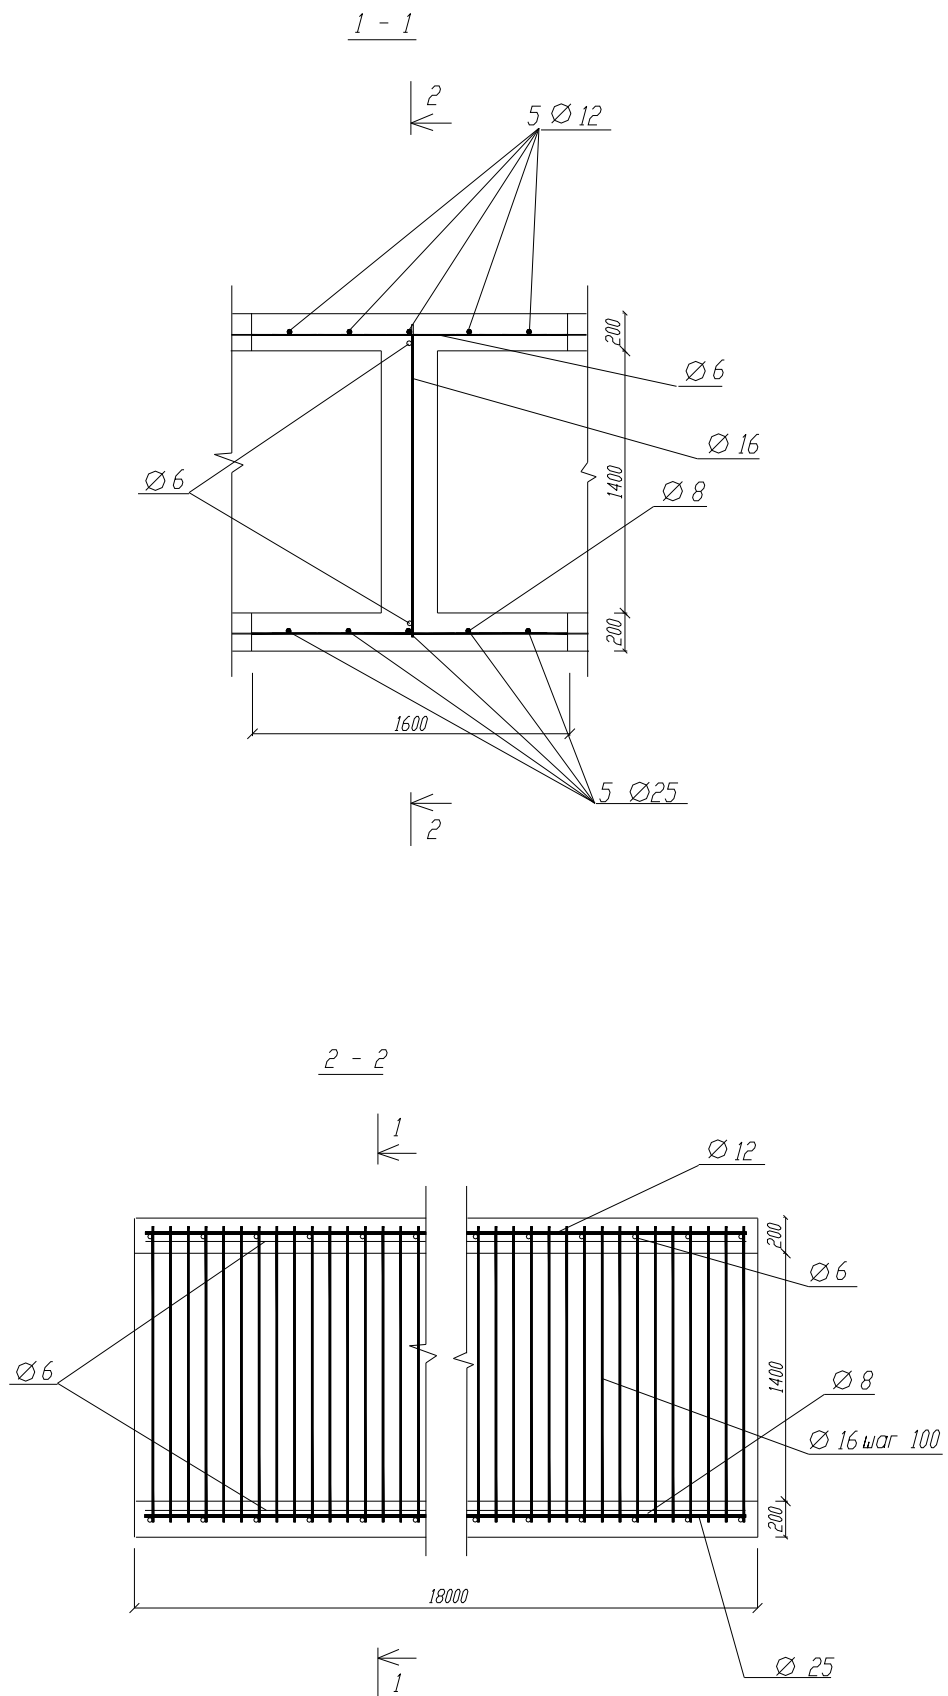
Схема армування фундаменту на ділянці між осями Б-Г та Ж-К
